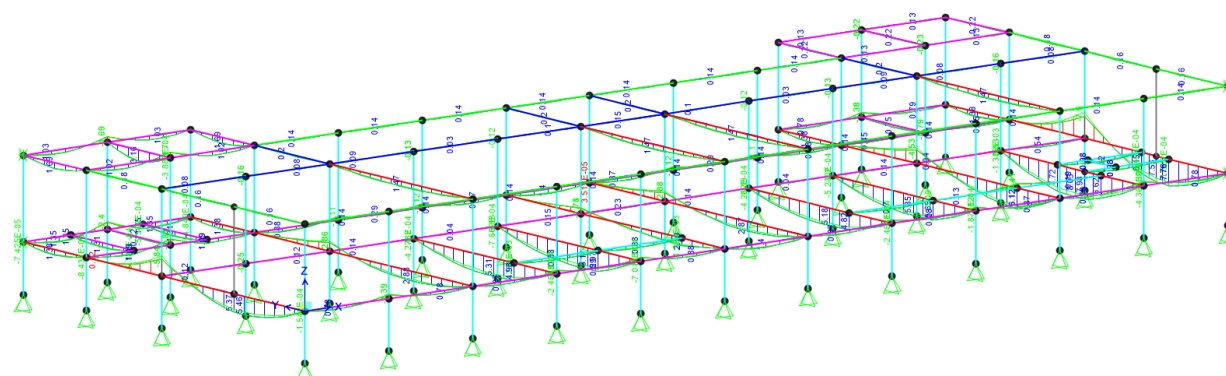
ESTRUCTURA DE HORMIGÓN | MOMENTO [Tonf.m]
